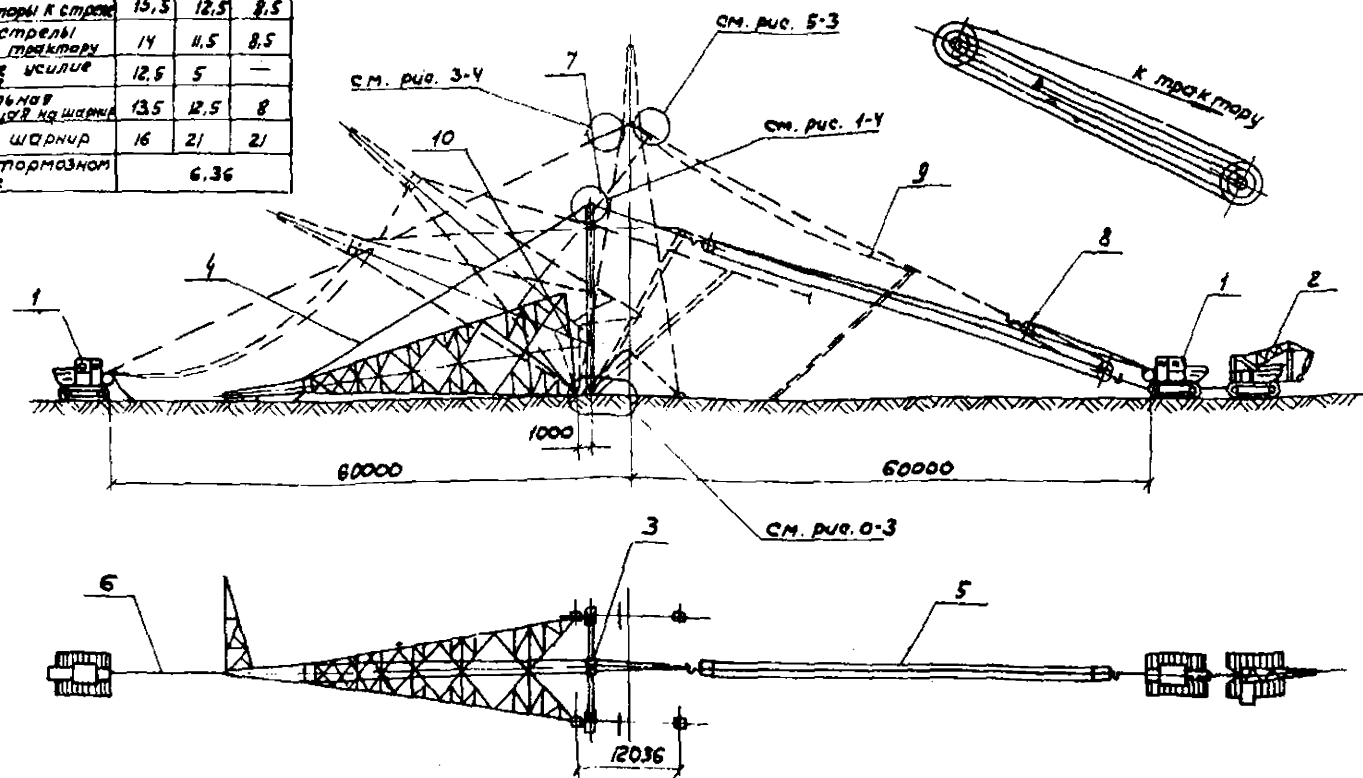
Схема подъема стайки опоры типа УС 750-1+10
